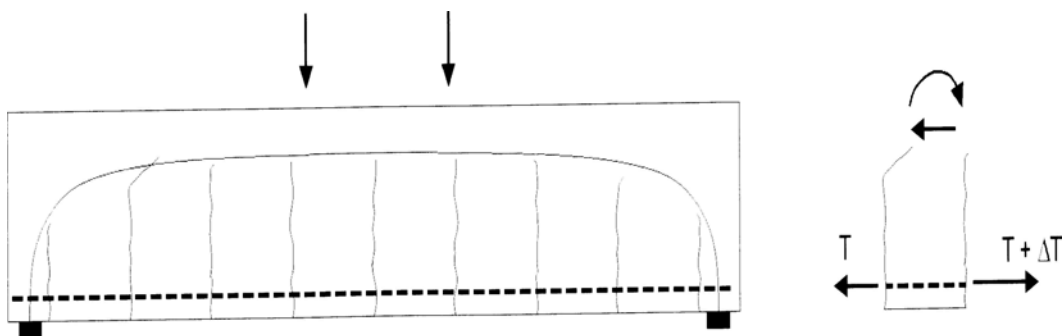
Modelo del peine de Kani para vigas fisuradas a cortante
